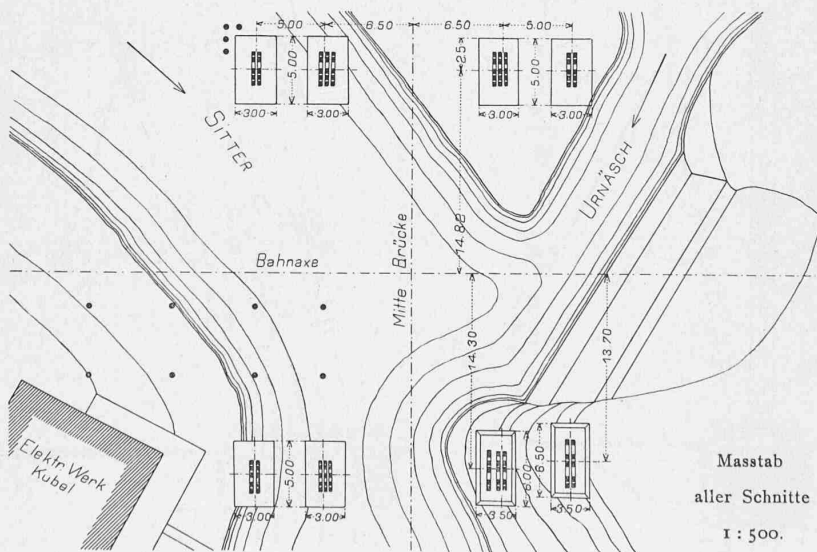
Horizontalschnitt des Gerüstturms über den Fundamentsockeln.
